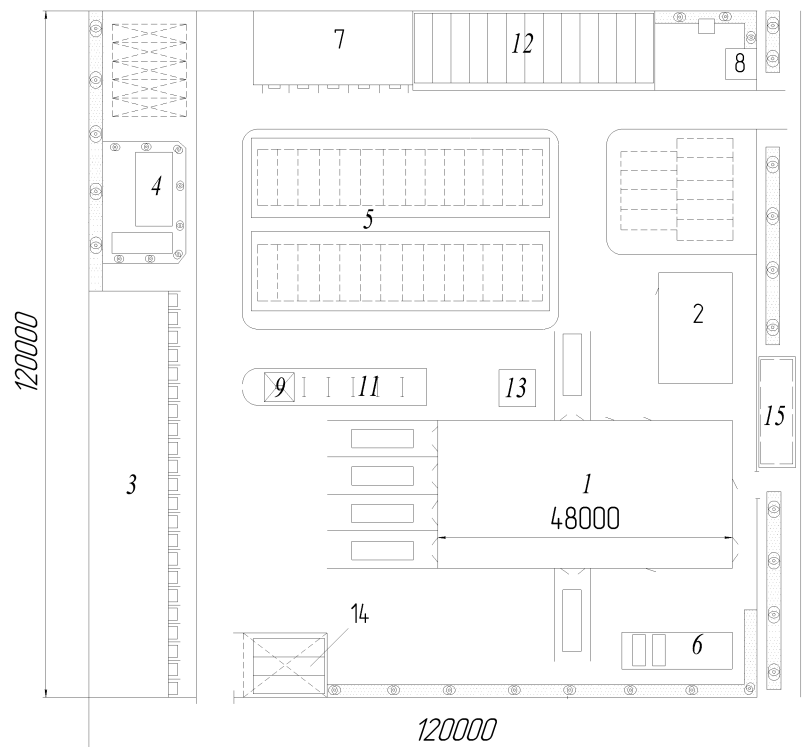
Генеральний план дорожнього ремонтно-будівельного управління:
